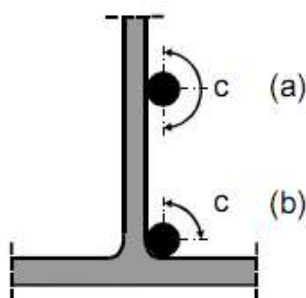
Perímetro efectivo c de la barra de armado
